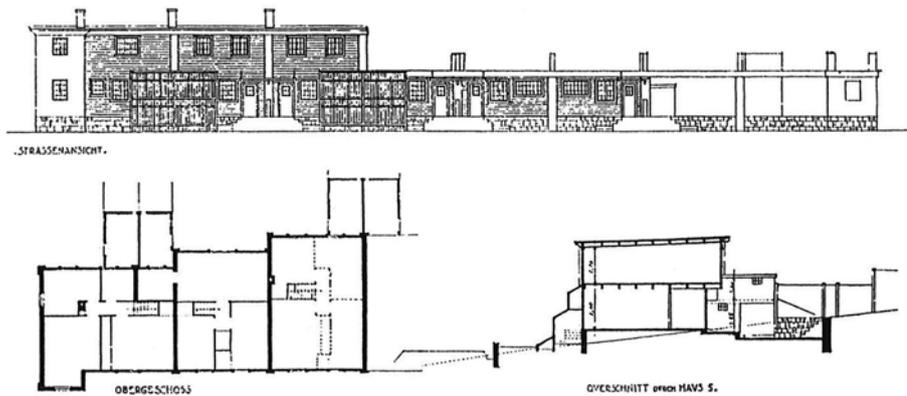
Siedlung am Heuberg - Ansicht, Grundriss, Schnitt
